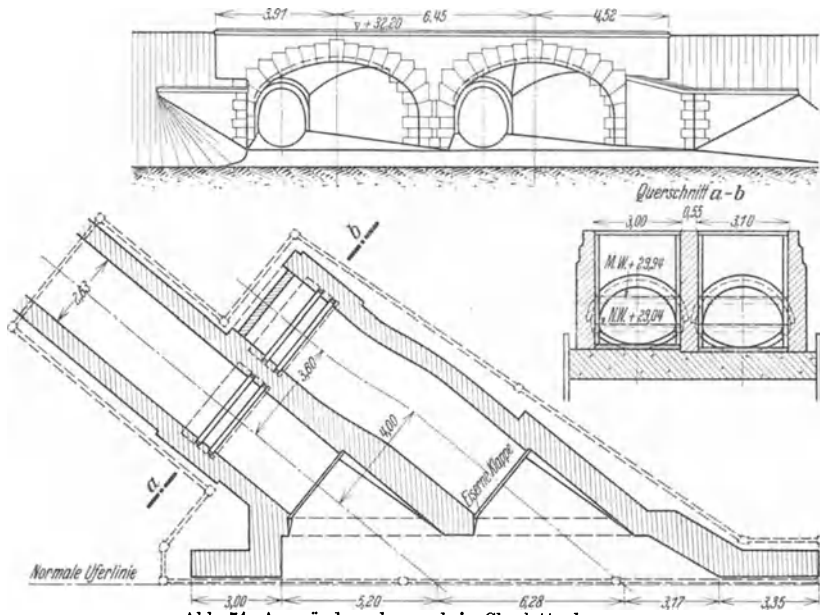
Ausmündungsbauwerk in Charlottenburg.
